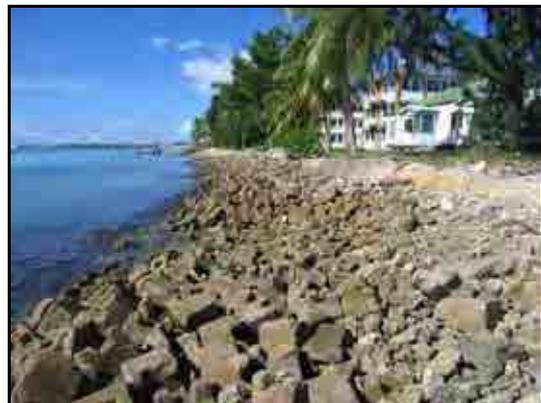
政府庁舎裏の海岸の状況
